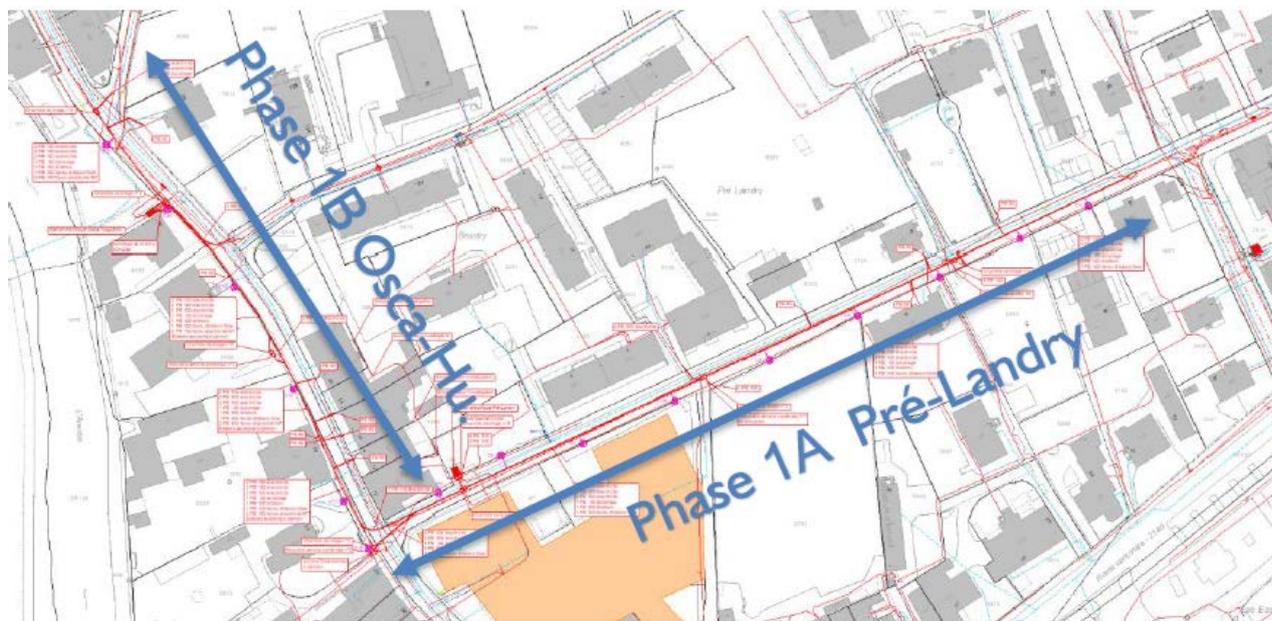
plan explicatif des travaux réalisés dans le cadre des travaux induits par le plan spécial
